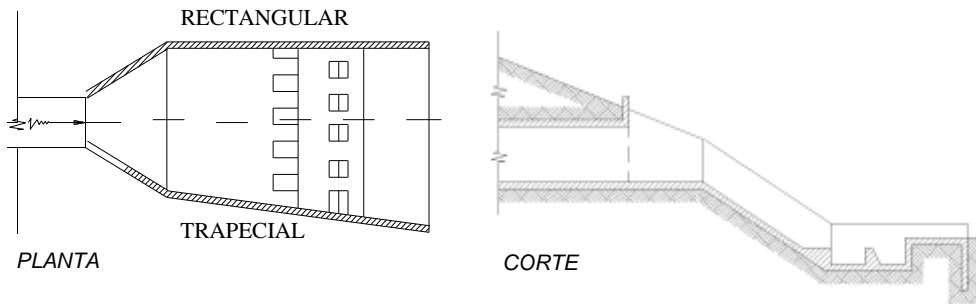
Terminal de alcantarilla con rápido de hormigón
